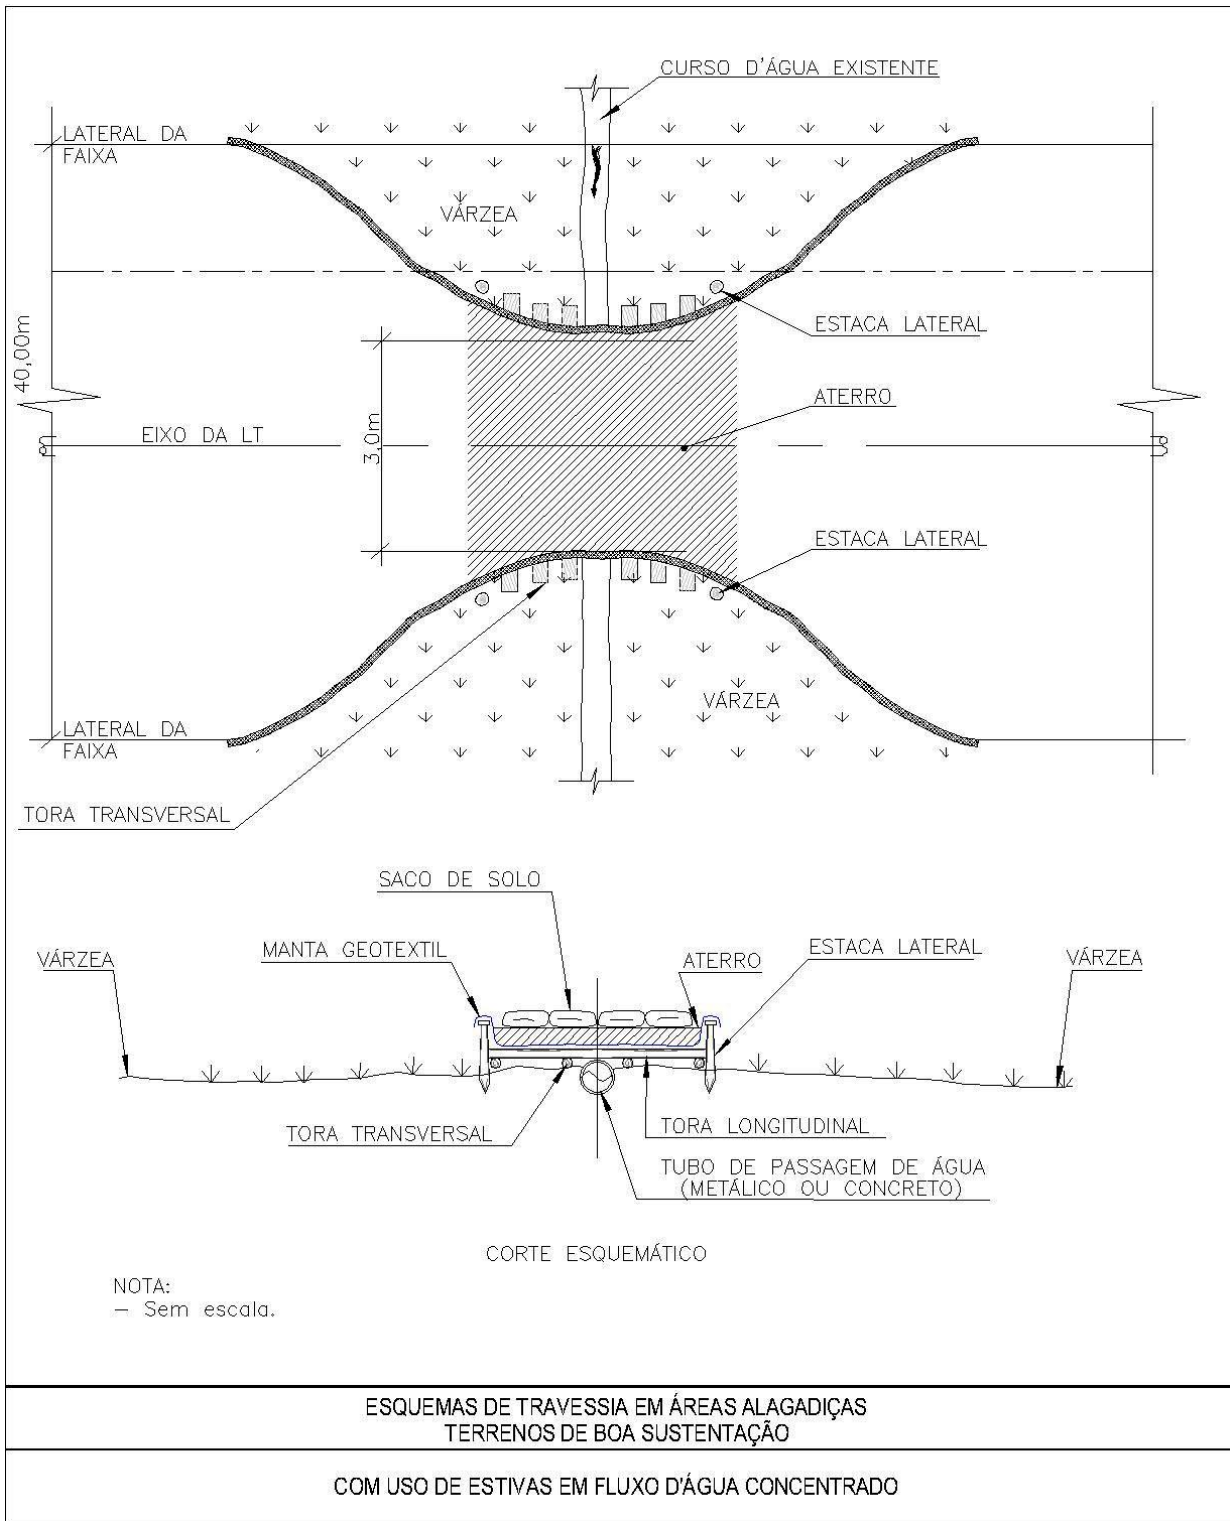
Construção em áreas de várzea, em terrenos de boa sustentação.
